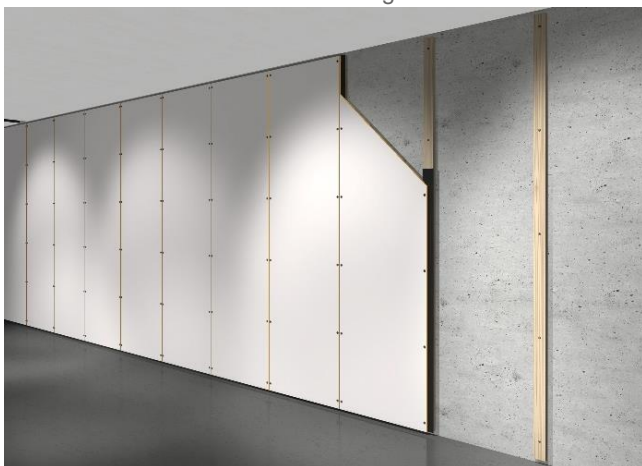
Subestrutura para revestimento de parede com painéis termolaminados
